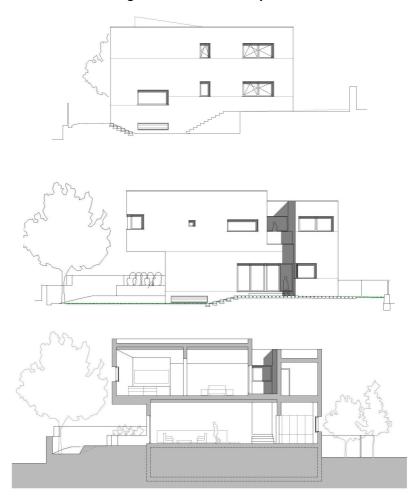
Fachadas Este, Sur y Sección de la vivienda
